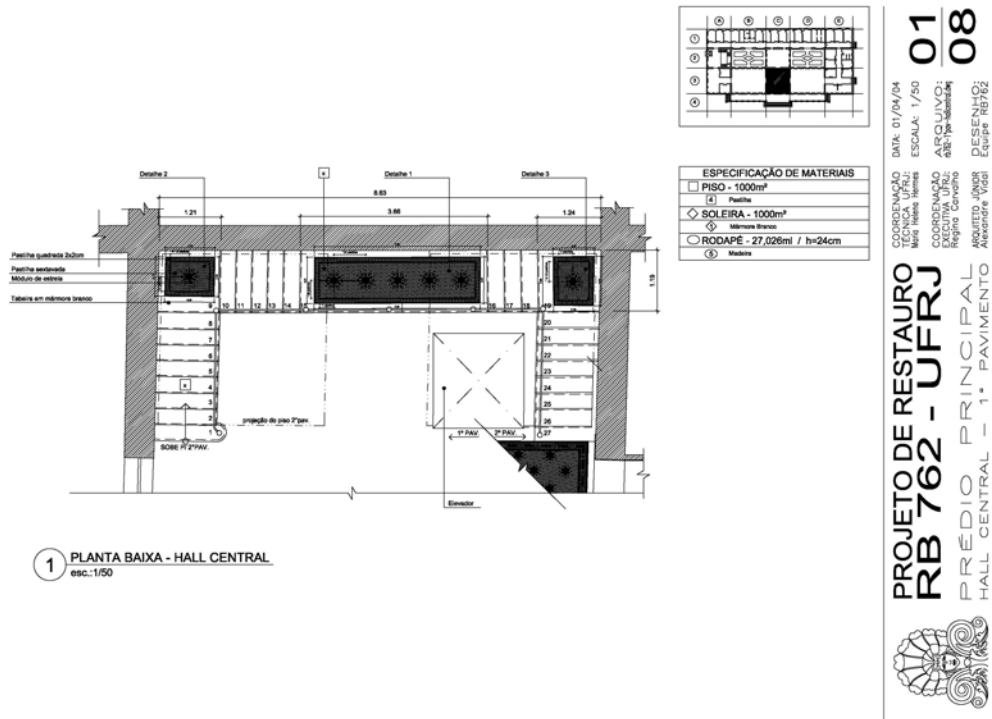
Caderno de Escadas, Balaustrada e Ferragens: Escada hall central – planta baixa – Prédio Principal.
